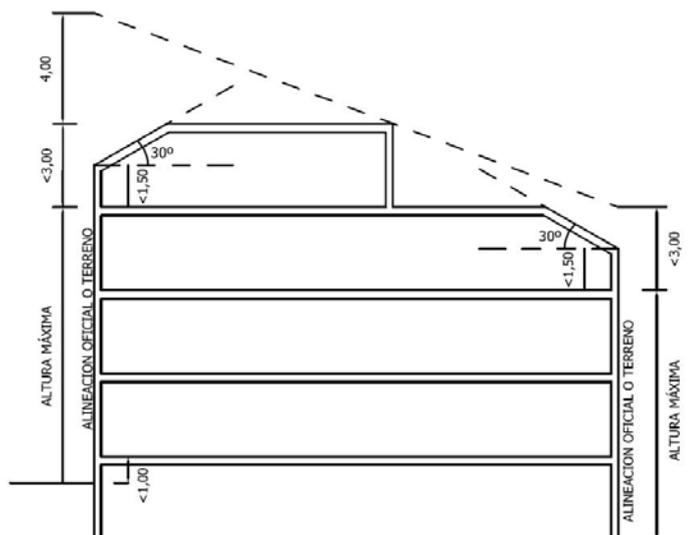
Trazado de la envolvente en zonas en las que no se permitan plantas ático ni cámaras
